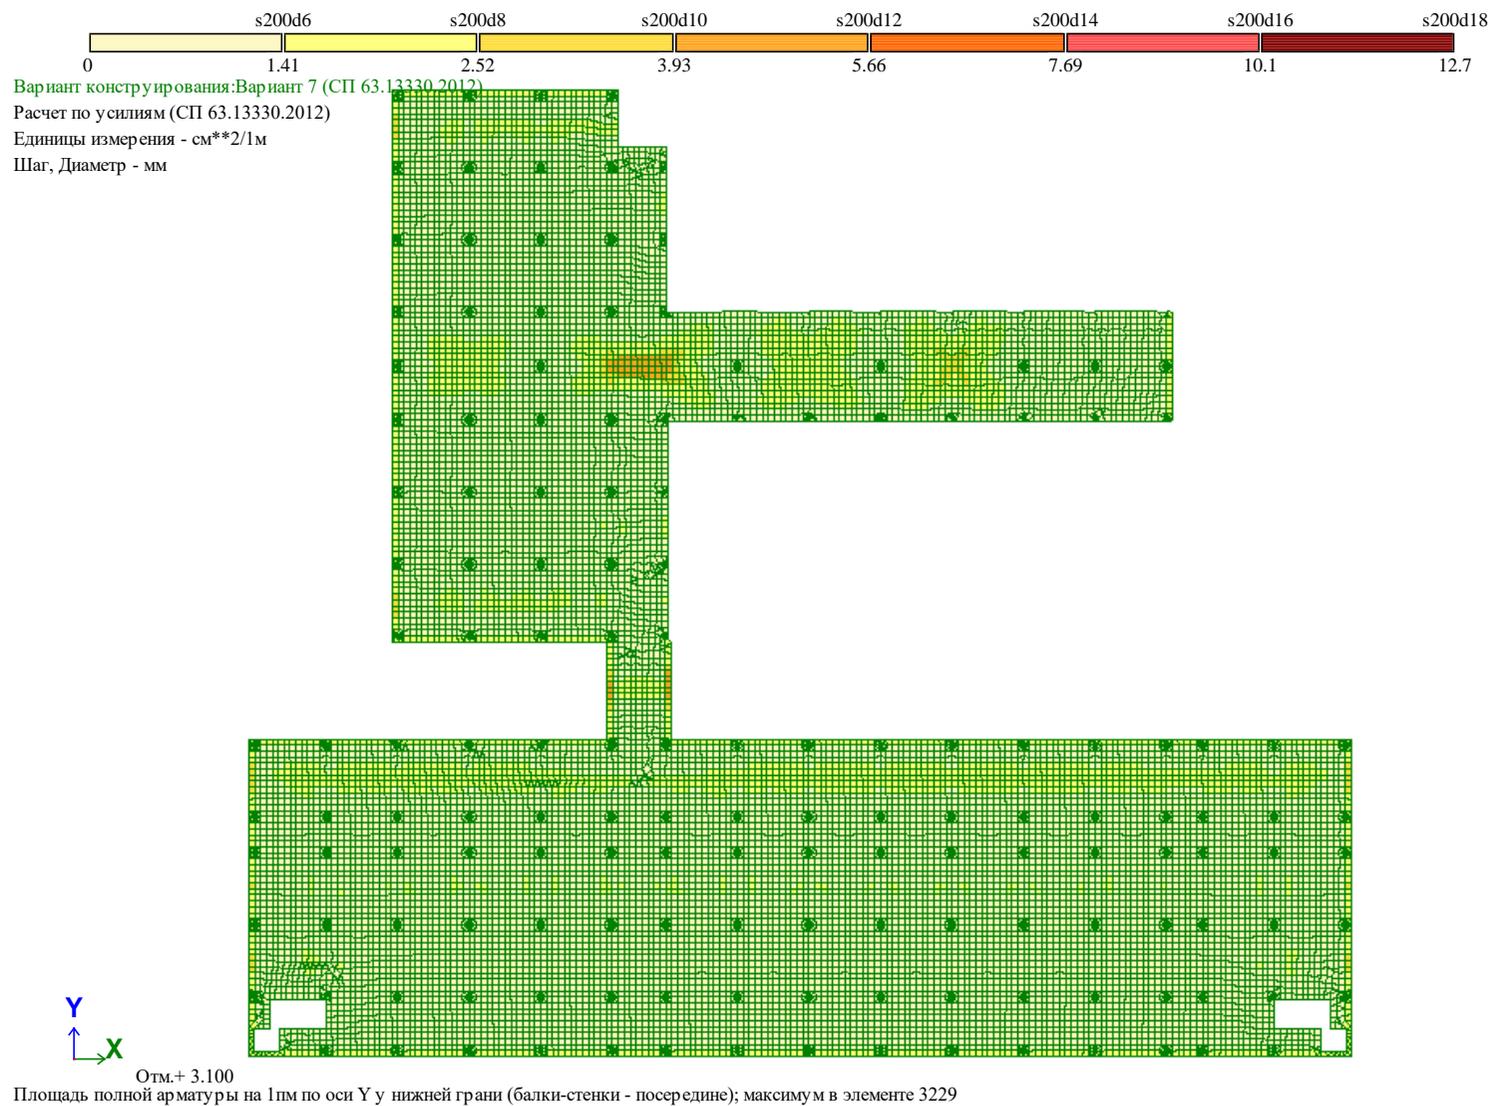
Мозаика нижнего армирования плиты перекрытия по оси Y_1
